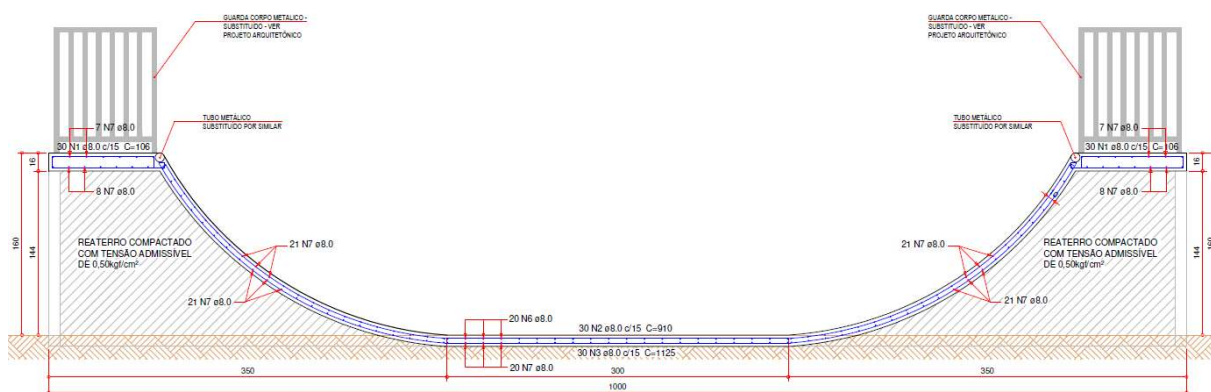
Posicionamento das Armaduras da Nova Laje a Ser Executada
